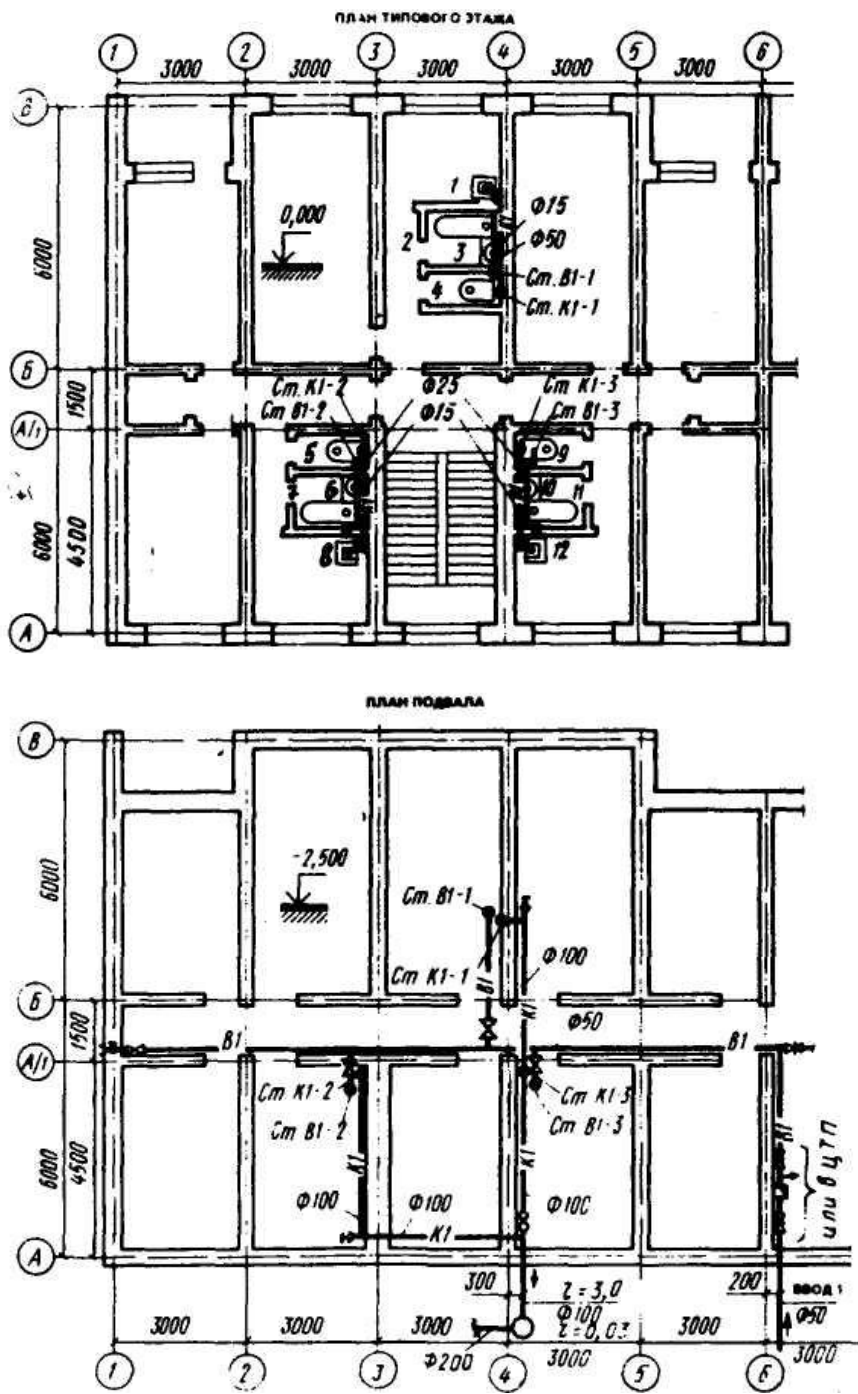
План типового этажа и план подвала с внутренними сетями водоснабжения и канализации
